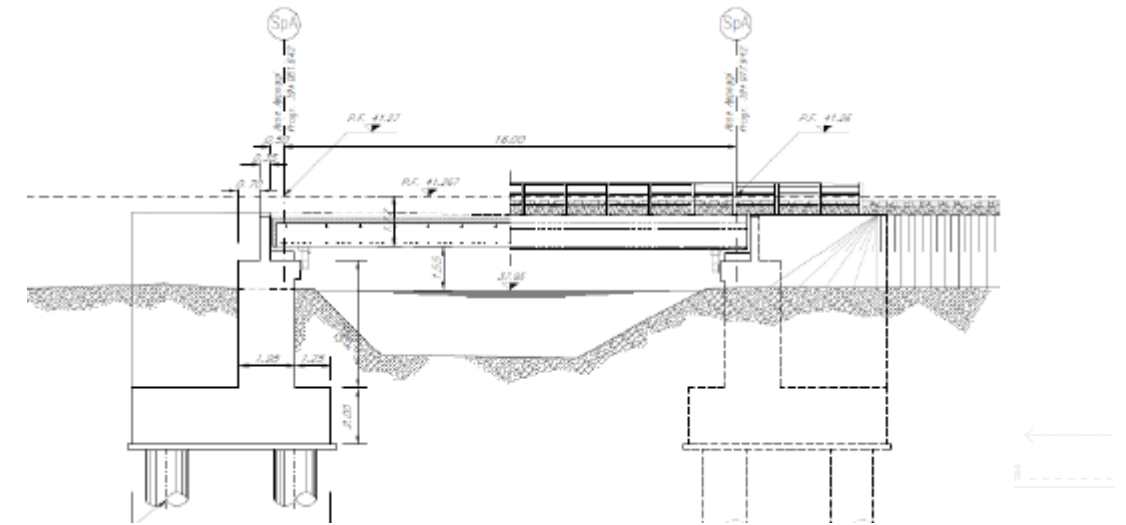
Prospetto/sezione longitudinale del viadotto VI04
